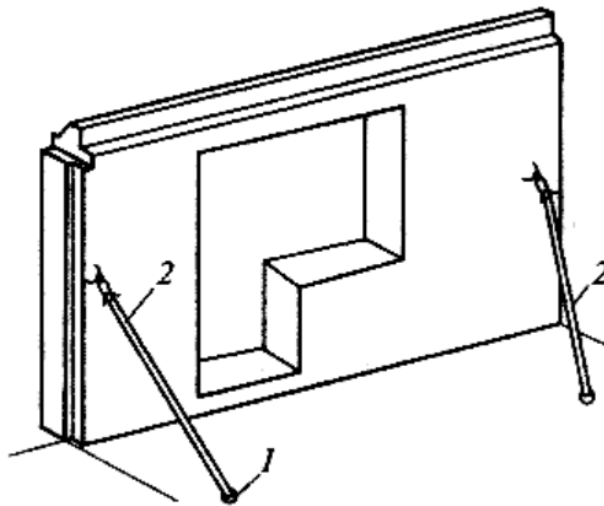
Схема тимчасового кріплення панелі зовнішньої стіни:
